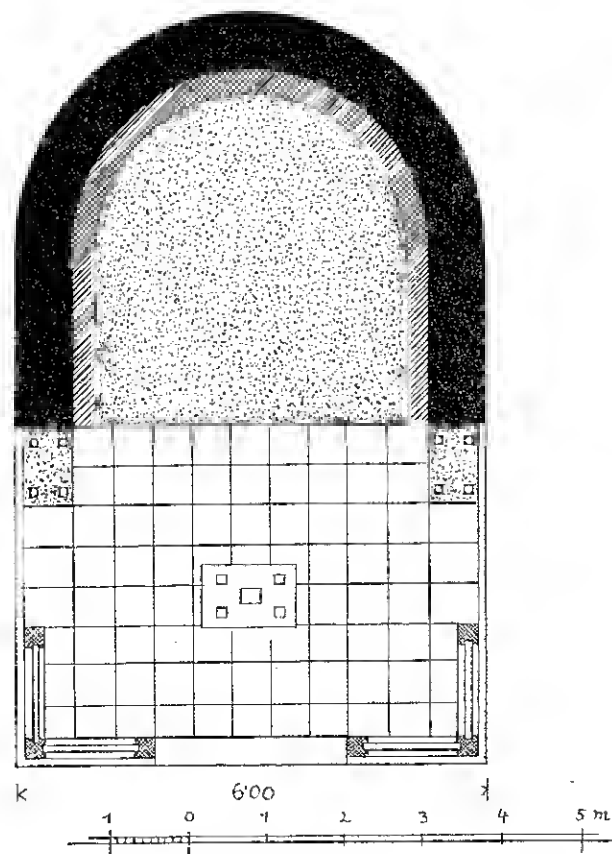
Basilique de Holz. Plan (d'après R. Egger).
